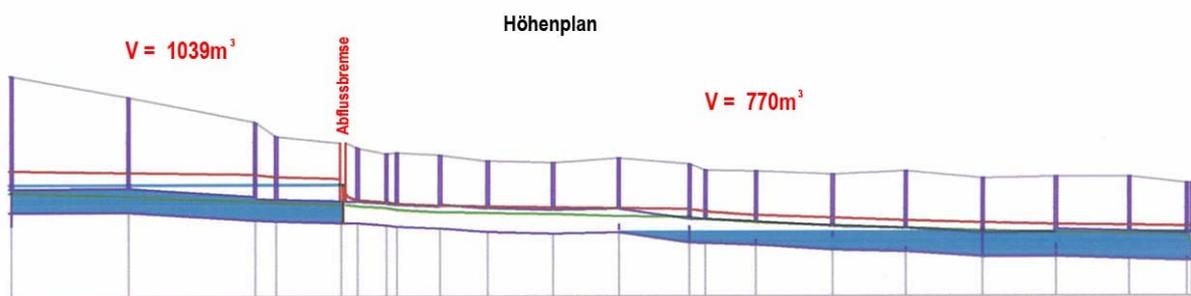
Höhenplan mit Speicherkaskaden im HS Lastenstraße
